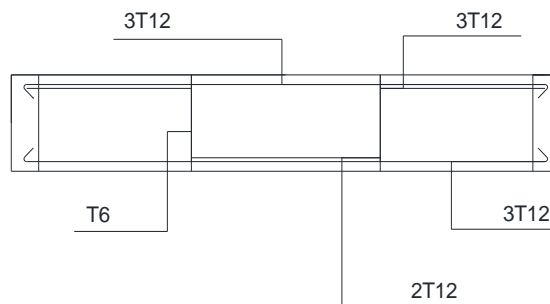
Coupe longitudinale d'une poutre noyée secondaire 20x30cm (plan fortement irrégulier)
